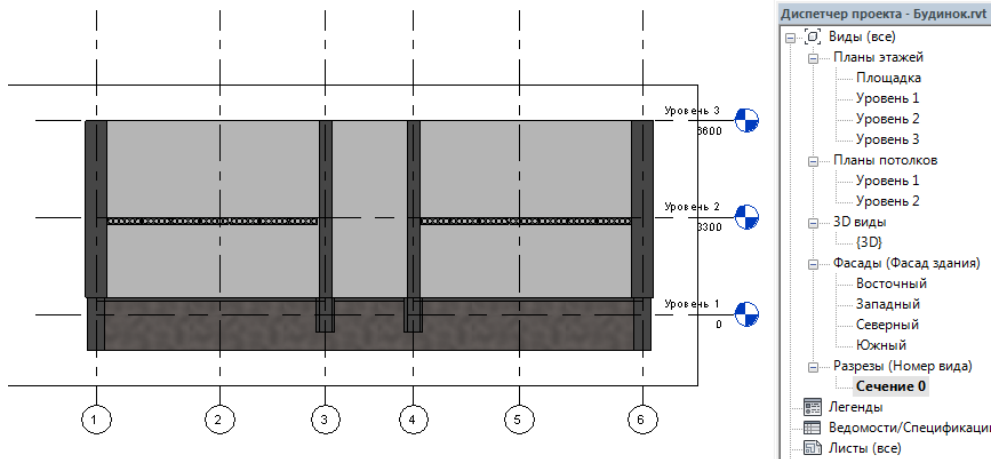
Коригування положення плити на повздовжньому перерізі будинку
